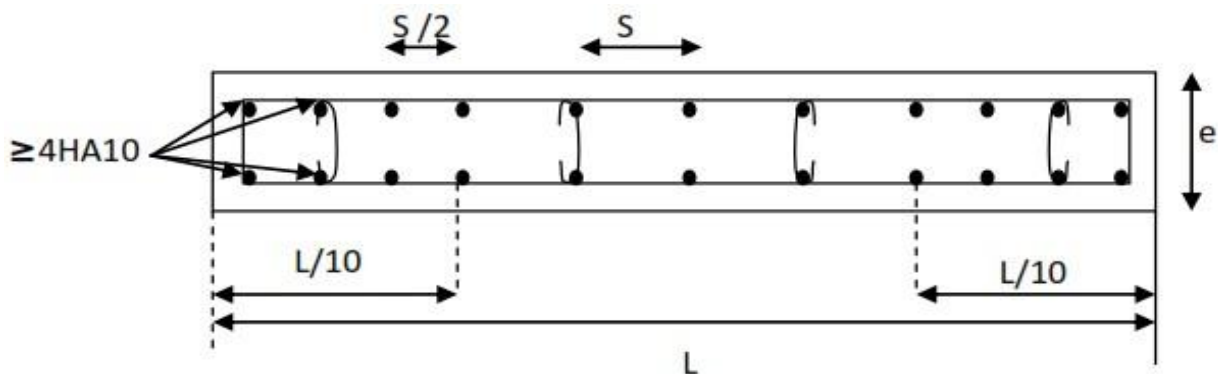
Disposition des armatures verticales dans les voiles.
